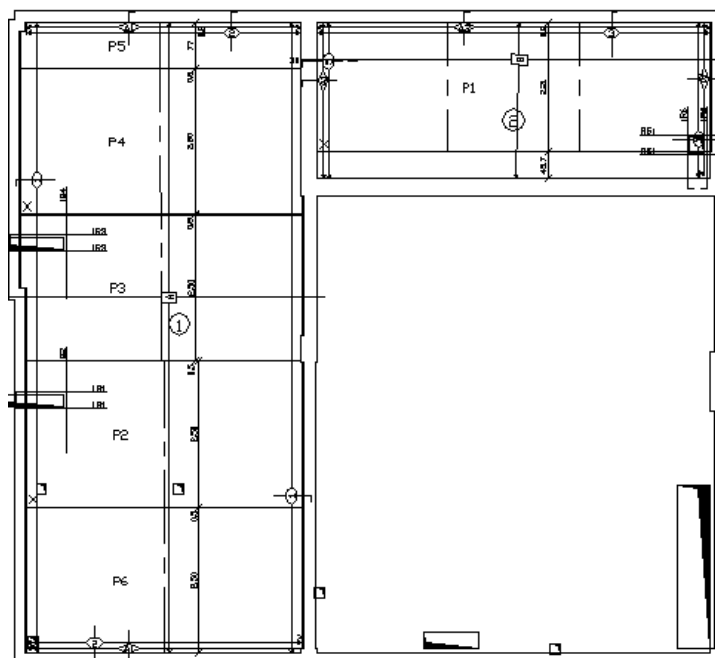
PLAN DE POSE DES PREDALLES JOINT 23 PH RDC
